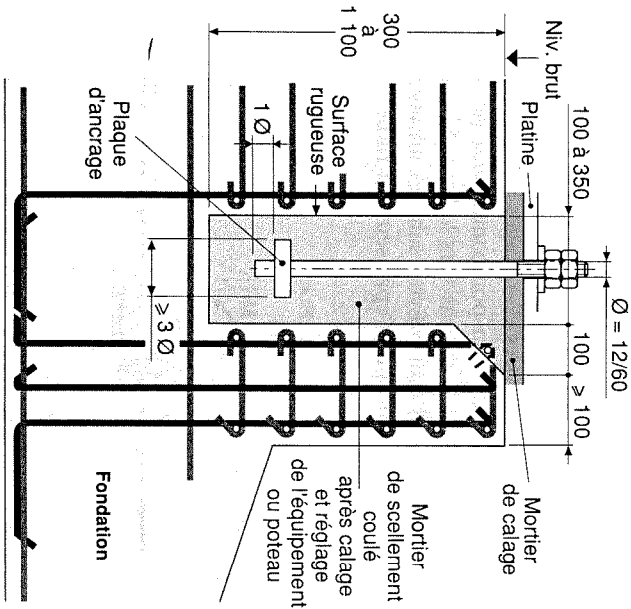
Détail d'ancrage des tiges avec plaque d'ancrage.
